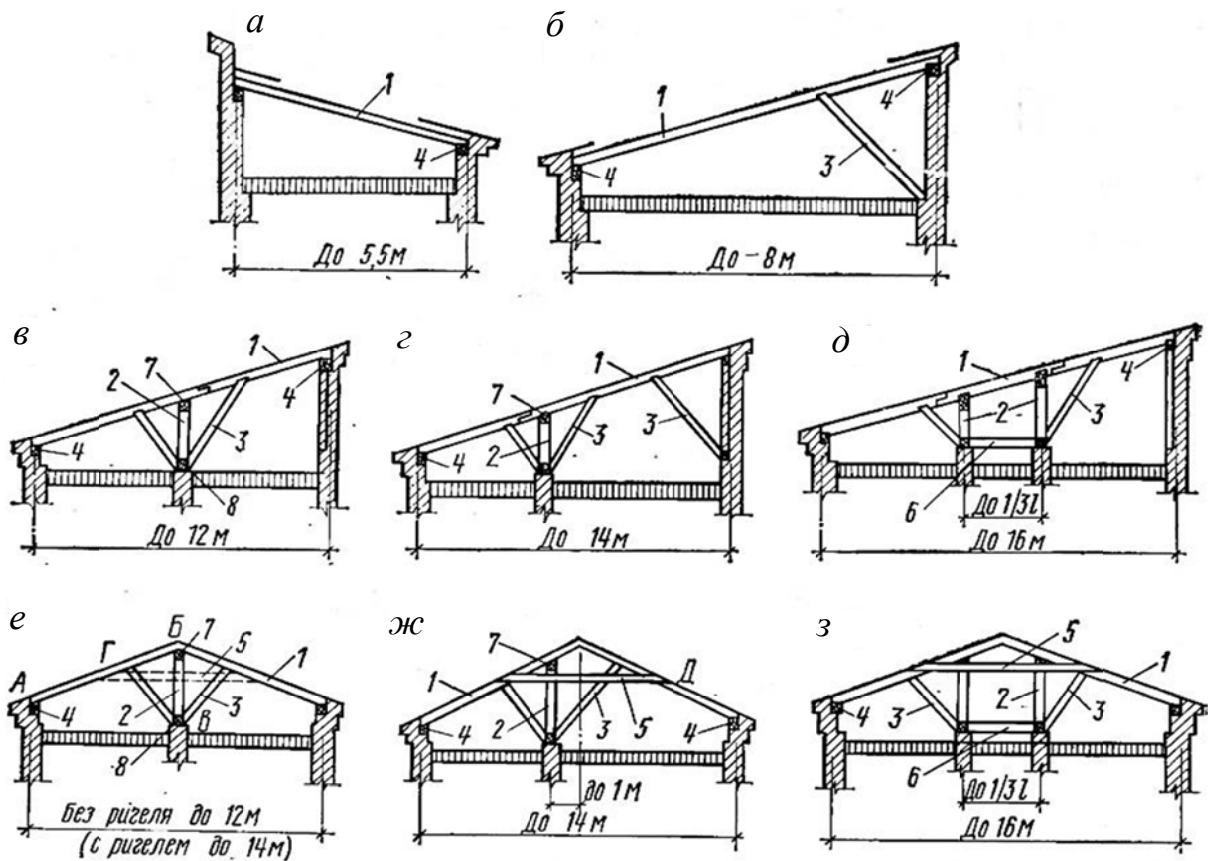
Конструктивные схемы деревянных наслонных стропил:
